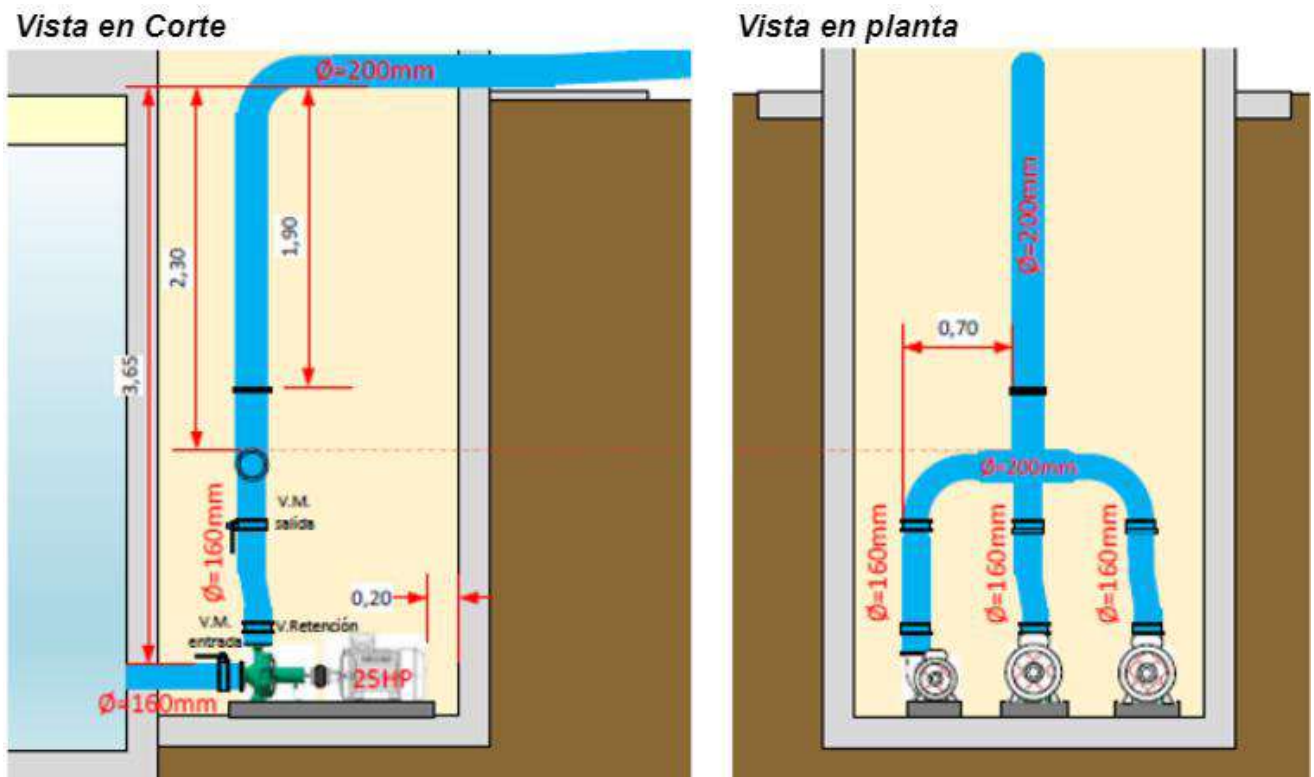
Sistema de bombeo existente en Planta y Corte – Fuente: Información Cooperativa
